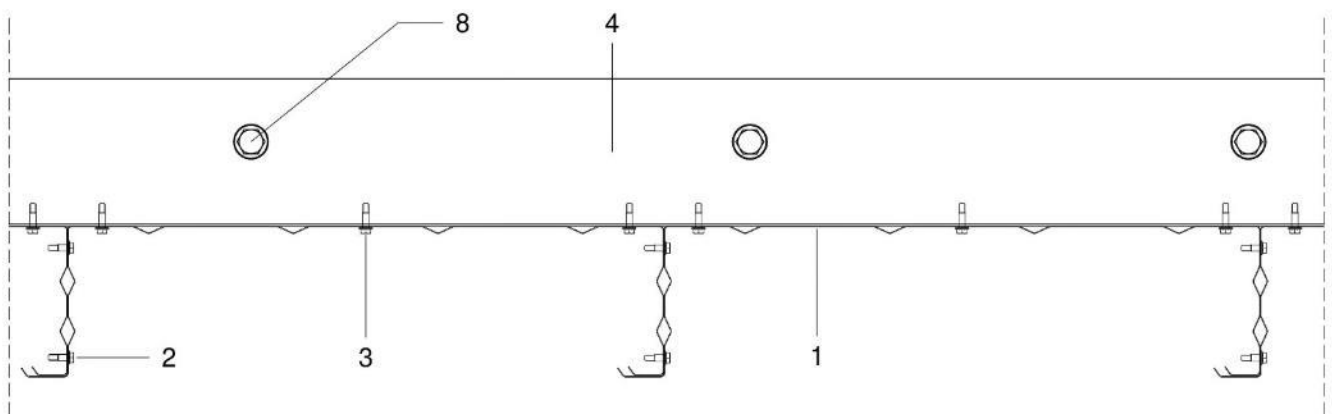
a: Sección horizontal sin aislamiento.
